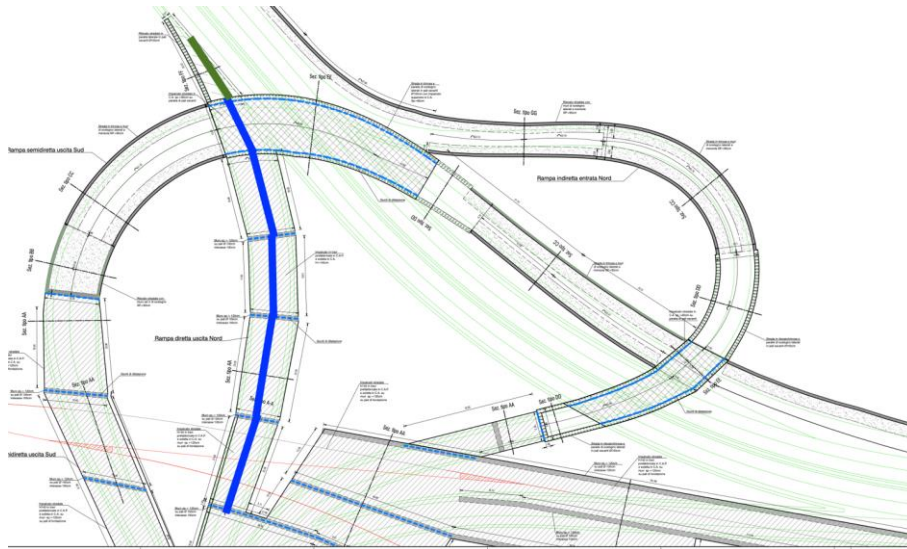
Planimetria con evidenziata la rampa diretta uscita Nord: in blu i tratti di rampa su impalcato e in verde il tratto in rilevato
